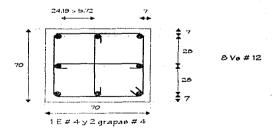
Armado de columna 12 (entrepiso N1), edificio de 7 niveles discñado en la zona !!
